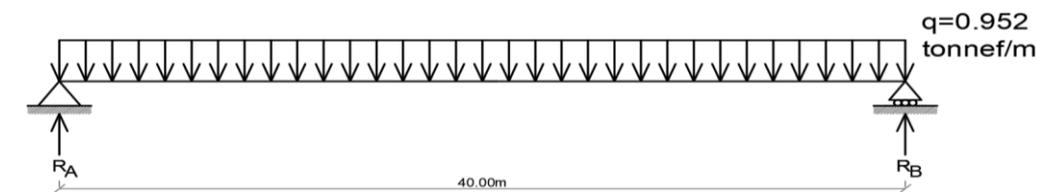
Carga viva de carril aplicada sobre la viga metálica [Elaboración propia]
